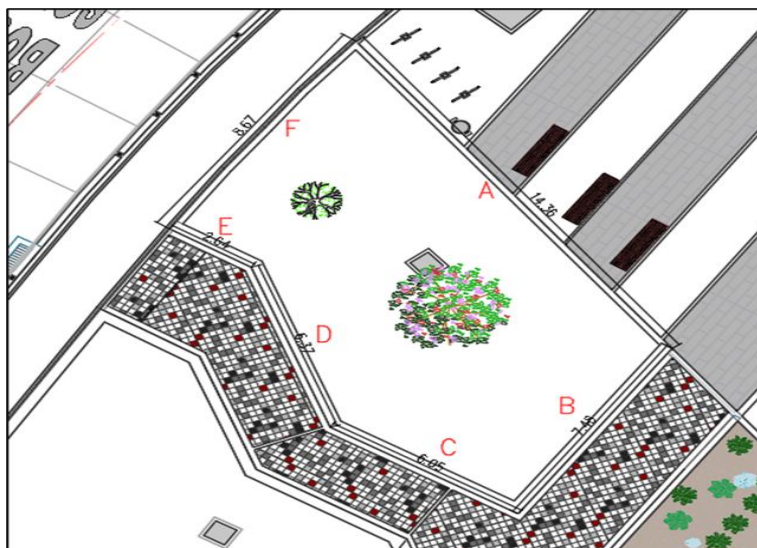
Planimetría en AutoCAD del plano récord de las obras de espacio público
